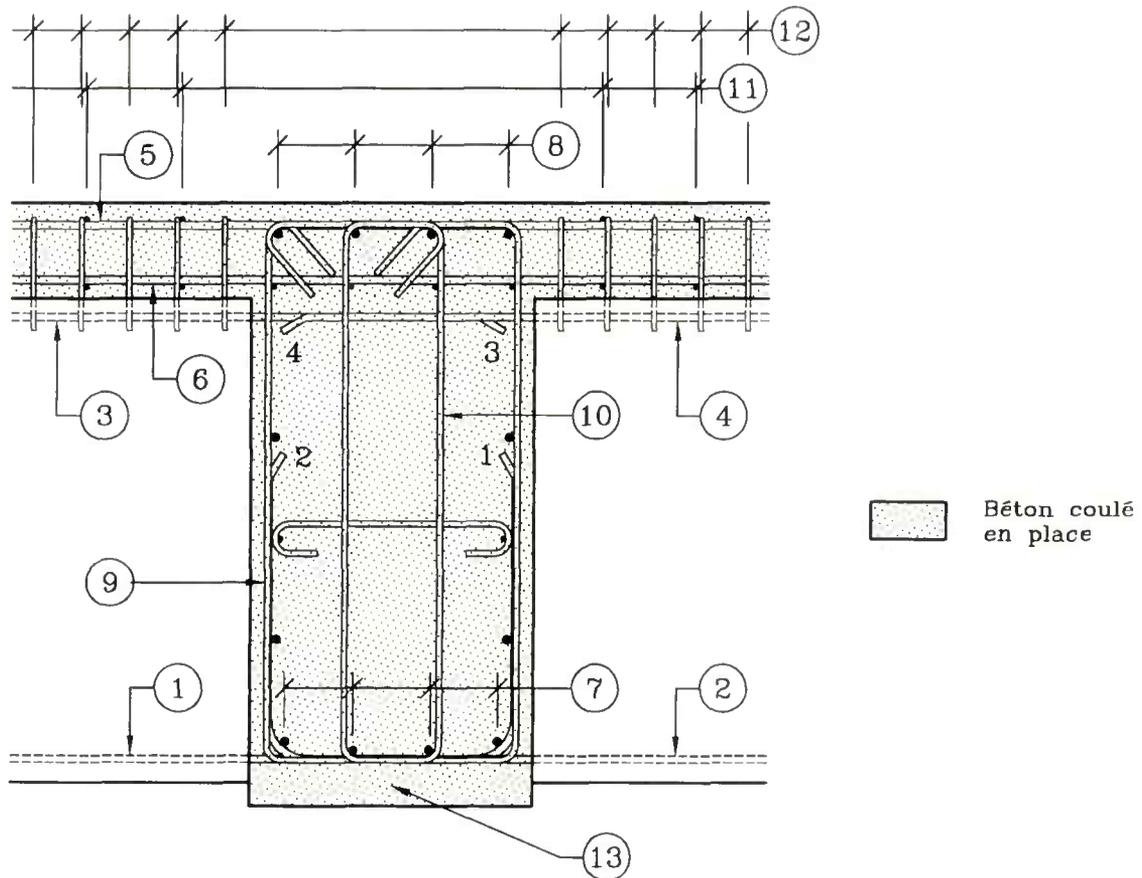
Principe du ferrailage supérieur d'encastrement du hourdis aux poutres et aux entretoises. Vue en plan.
